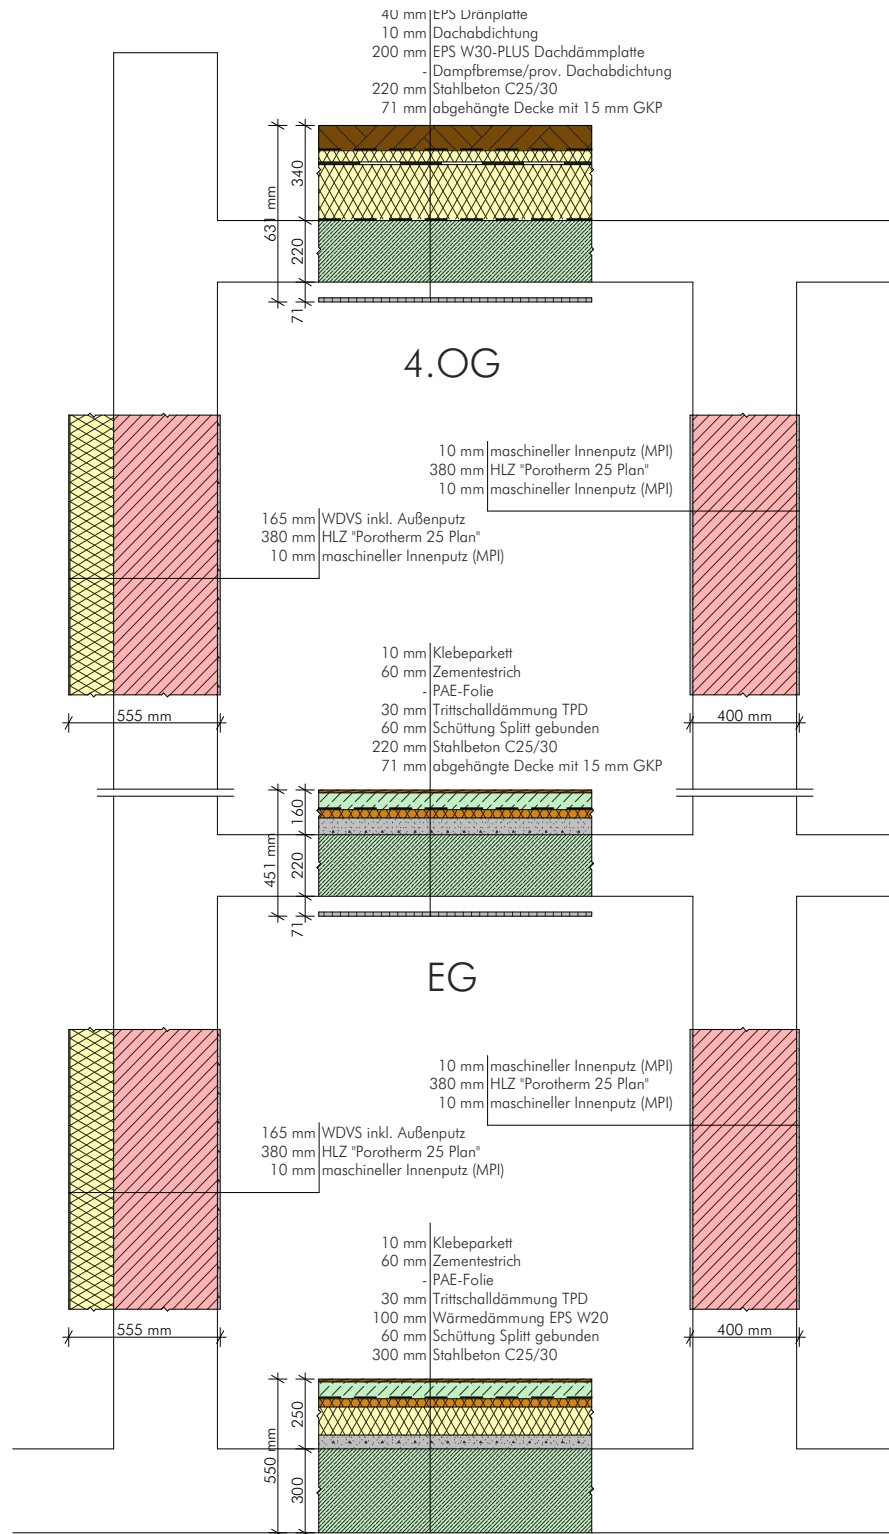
Situierung der Bauteilaufbauten anhand eines Fassadenschnittes
